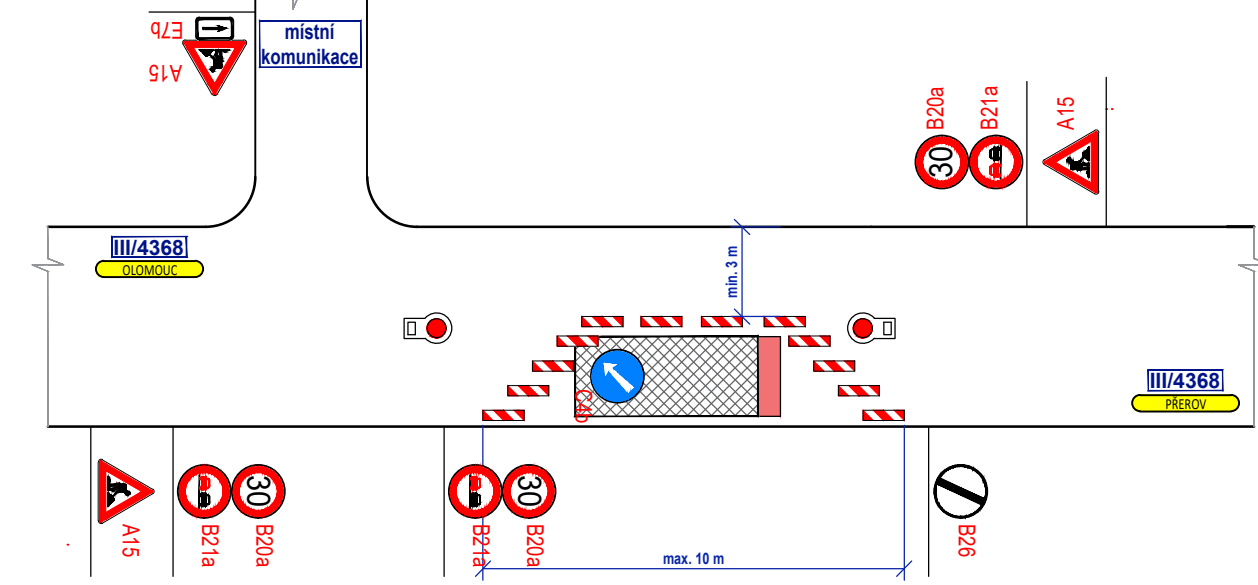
### DETAIL PRACOVNÍHO MÍSTA 3 - INTRAVILÁN
